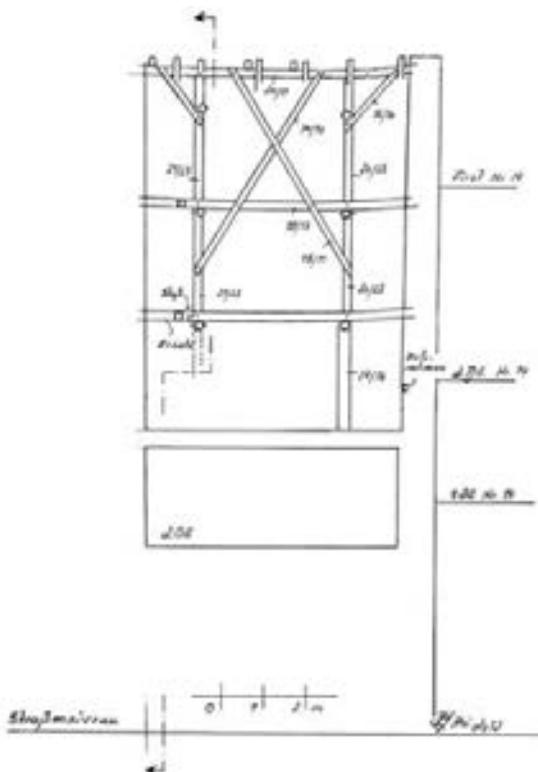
Villingen, Zinsergasse 16, Längsschnitt durch das Dachwerk von 1349(d).
